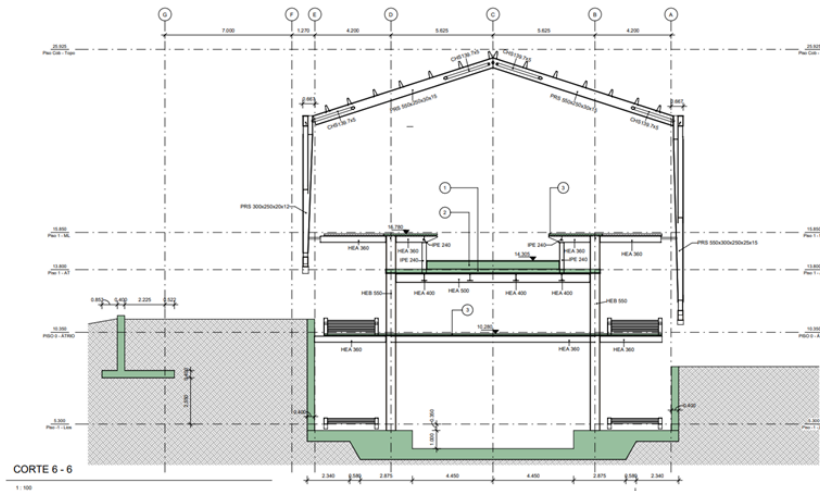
Secção transversal tipo da estrutura da estação – zona sem pilares
